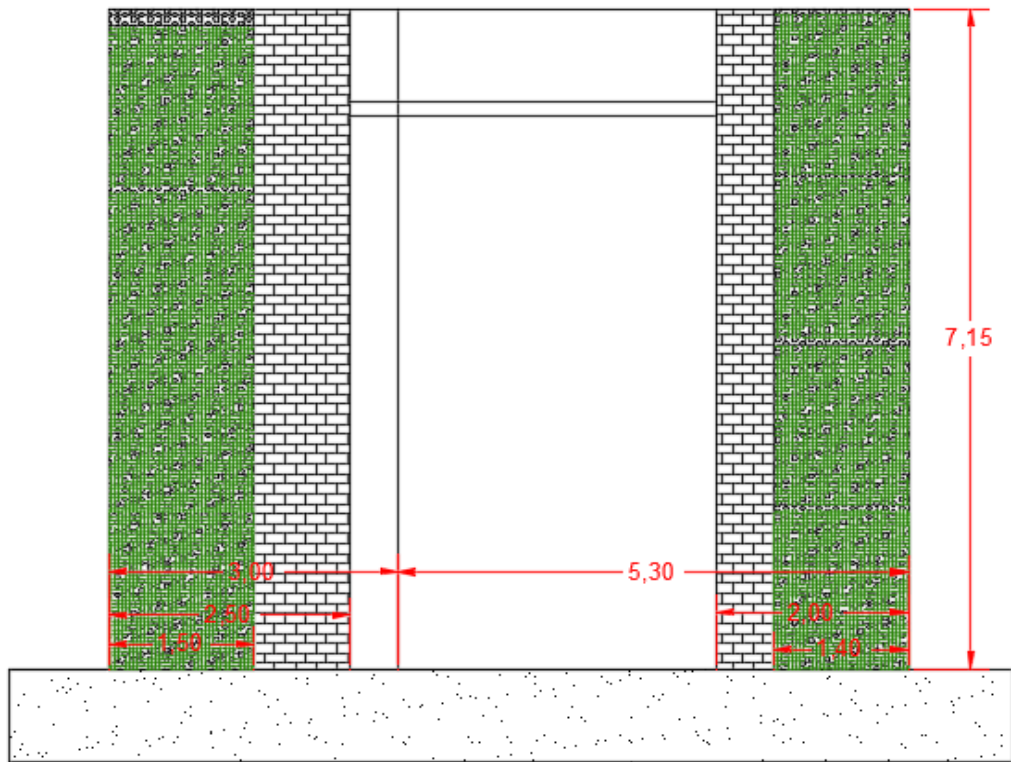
Fachada com brises e plantas (jardim vertical). Fonte: elaborado pelo pesquisador, através do software CAD.
